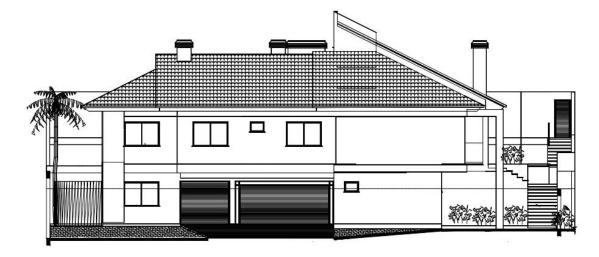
Fachada Oeste Fonte: Projeto Arquitetônico (2017)
